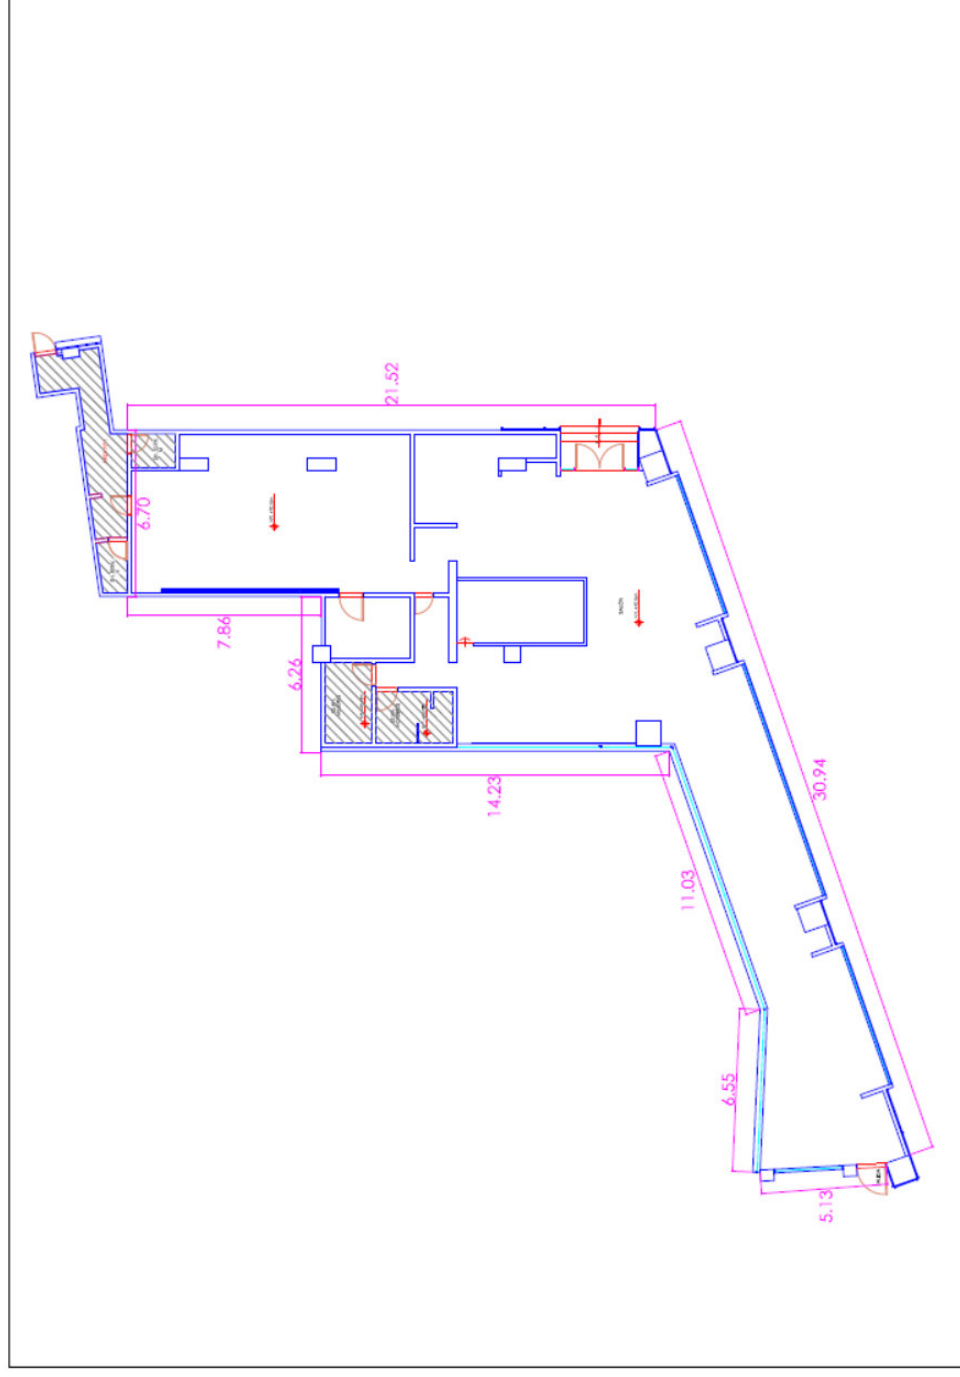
Vista del plano de planta del locatario en donde se especifica las medidas y orientación del local
